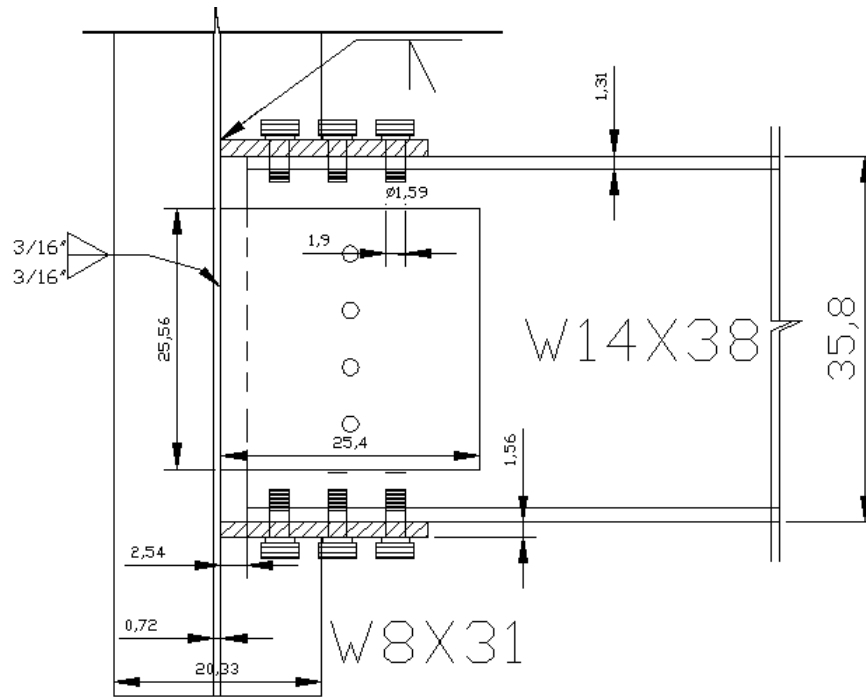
Vista en elevación de conexión. (Cotas en centímetros).
